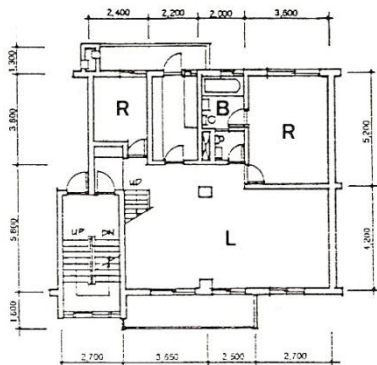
Untergeschossgrundriss einer doppelgeschossiger
